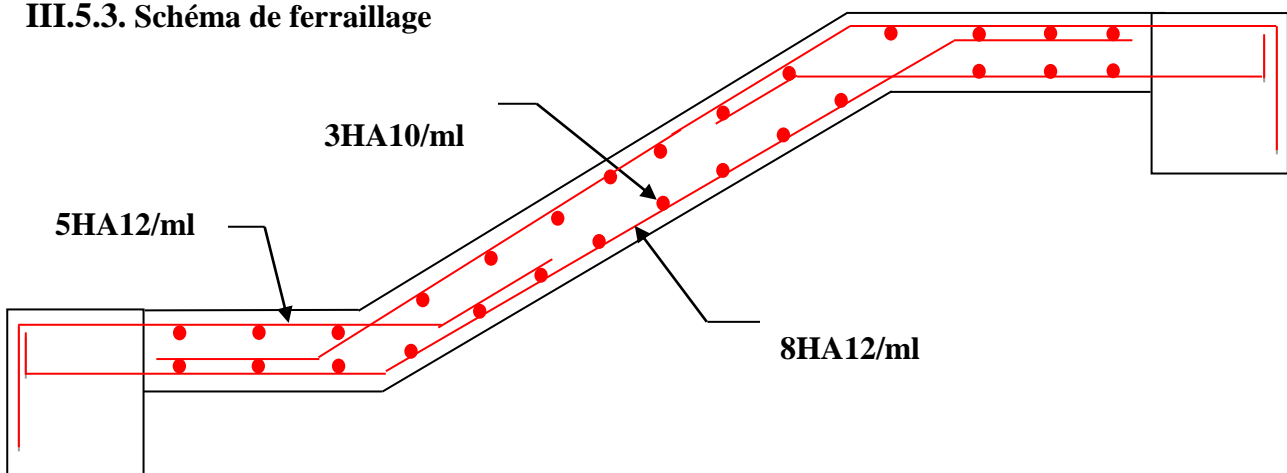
Schéma de ferrailage de l'escalier type (1)
